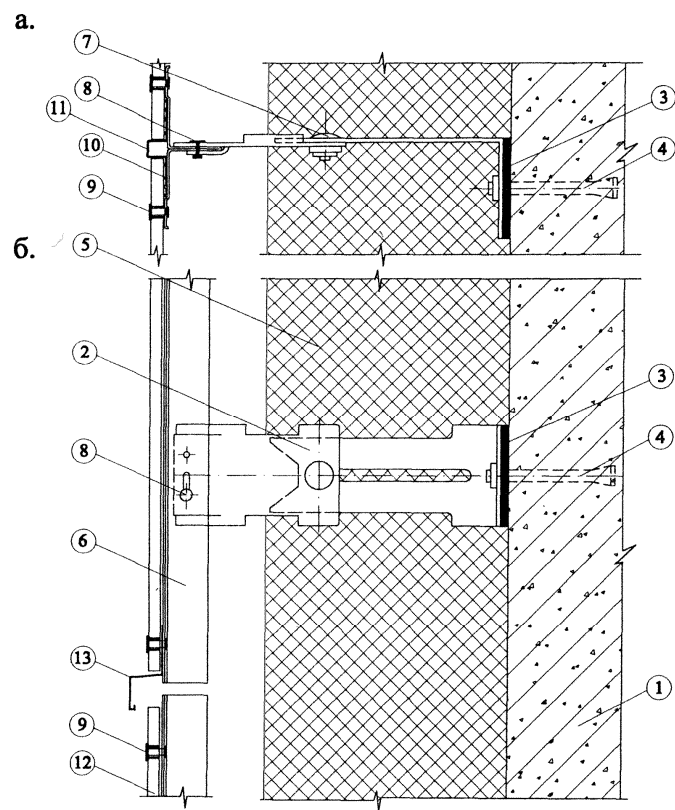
Разрез фасадной системы с облицовкой плитами «КраспанСтоун» и «КраспанКолор»
